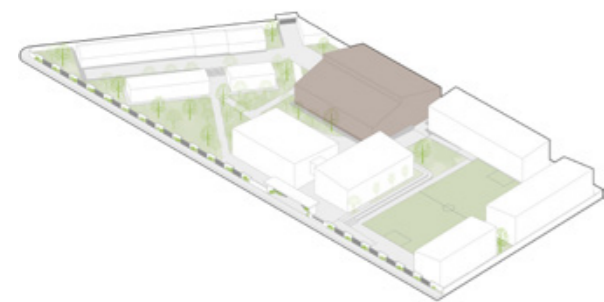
Planta cancha multiusos. Fuente: Elaboración propia.
